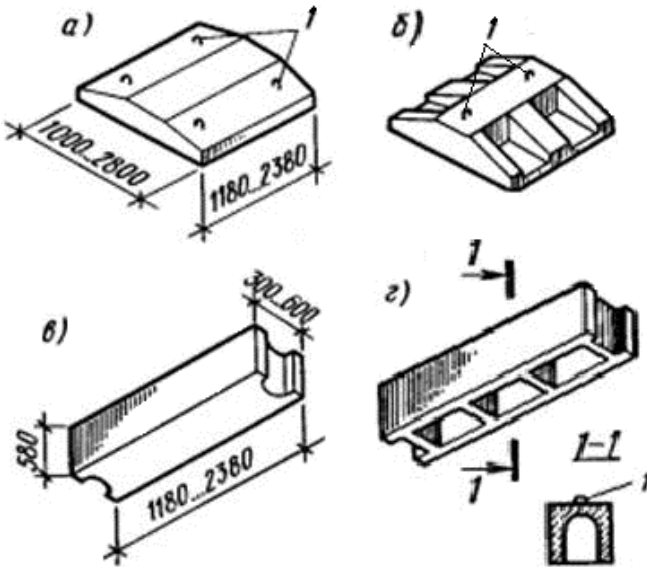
Елементи збірних залізобетонних фундаментів: *а* – суцільна фундаментна блок-подушка; *б* – ребриста фундаментна блок-подушка; *в* – стіновий фундаментний блок суцільний; *г* – стіновий фундаментний блок пустотілий; 1 – монтажні петлі
